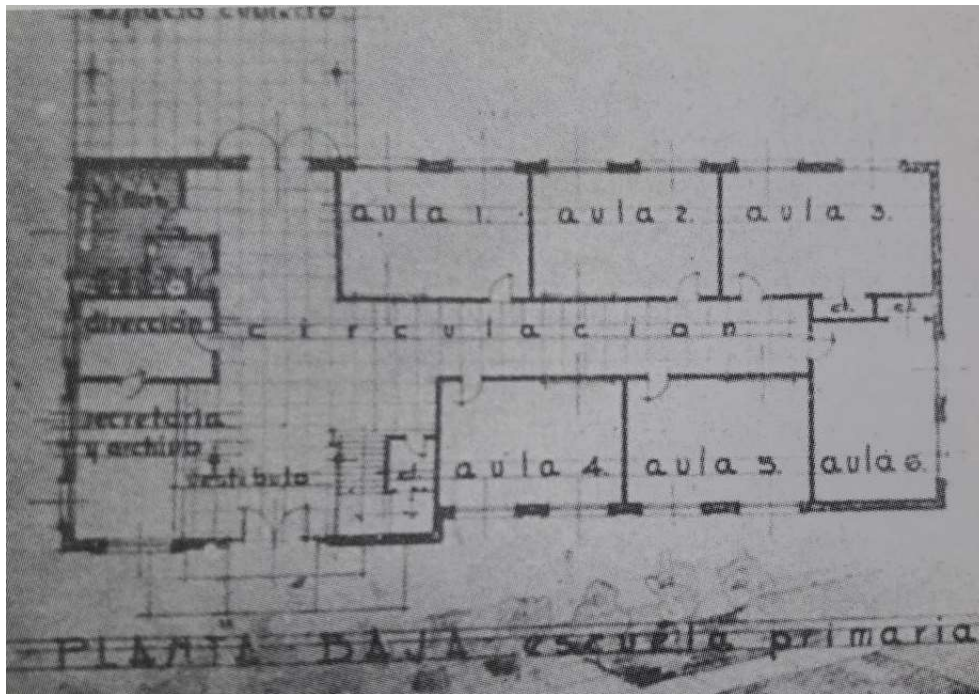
Planta baja del anteproyecto para la escuela primaria y secundaria de Nogales.
